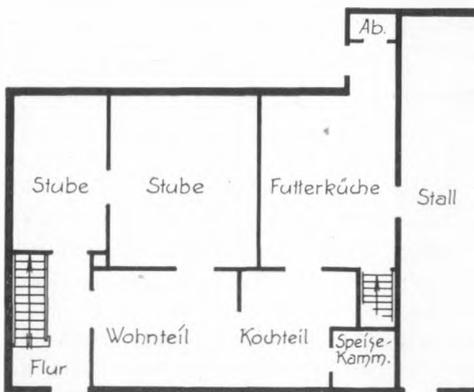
Angebautes Wohnhaus mit 3 Wohnräumen und Futterküche im Erdgeschoß. Zwei weitere Zimmer können im Dachgeschoß abseits der äußeren Giebelwand ausgebaut werden.
